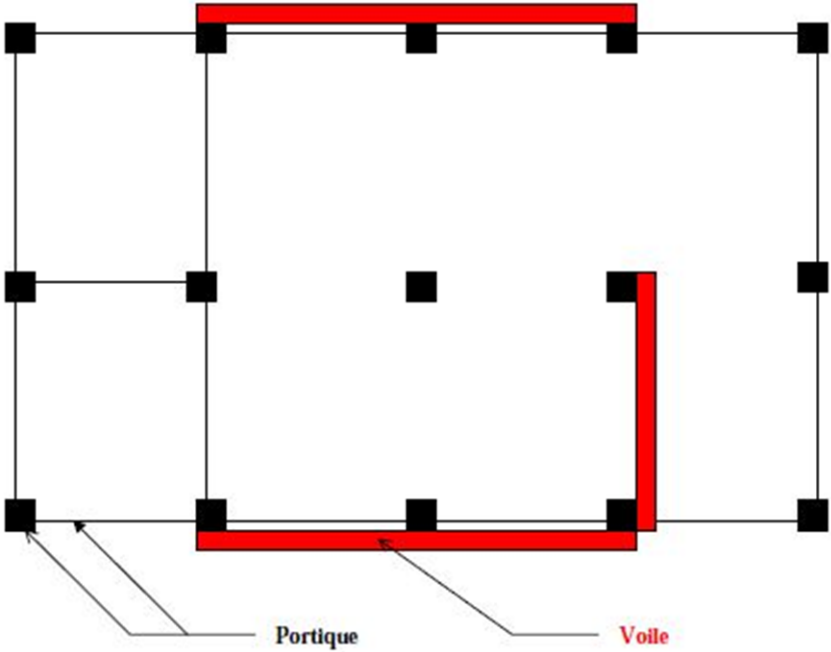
Structure mixte avec des voiles et des portiques [2]
